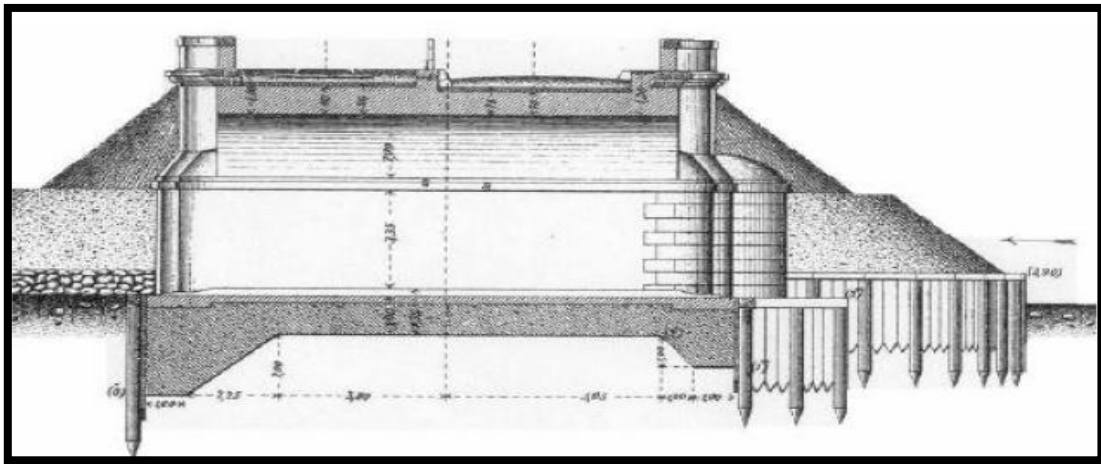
Fondazione a platea.* (Fonte:RABIOLI,R 1993).
